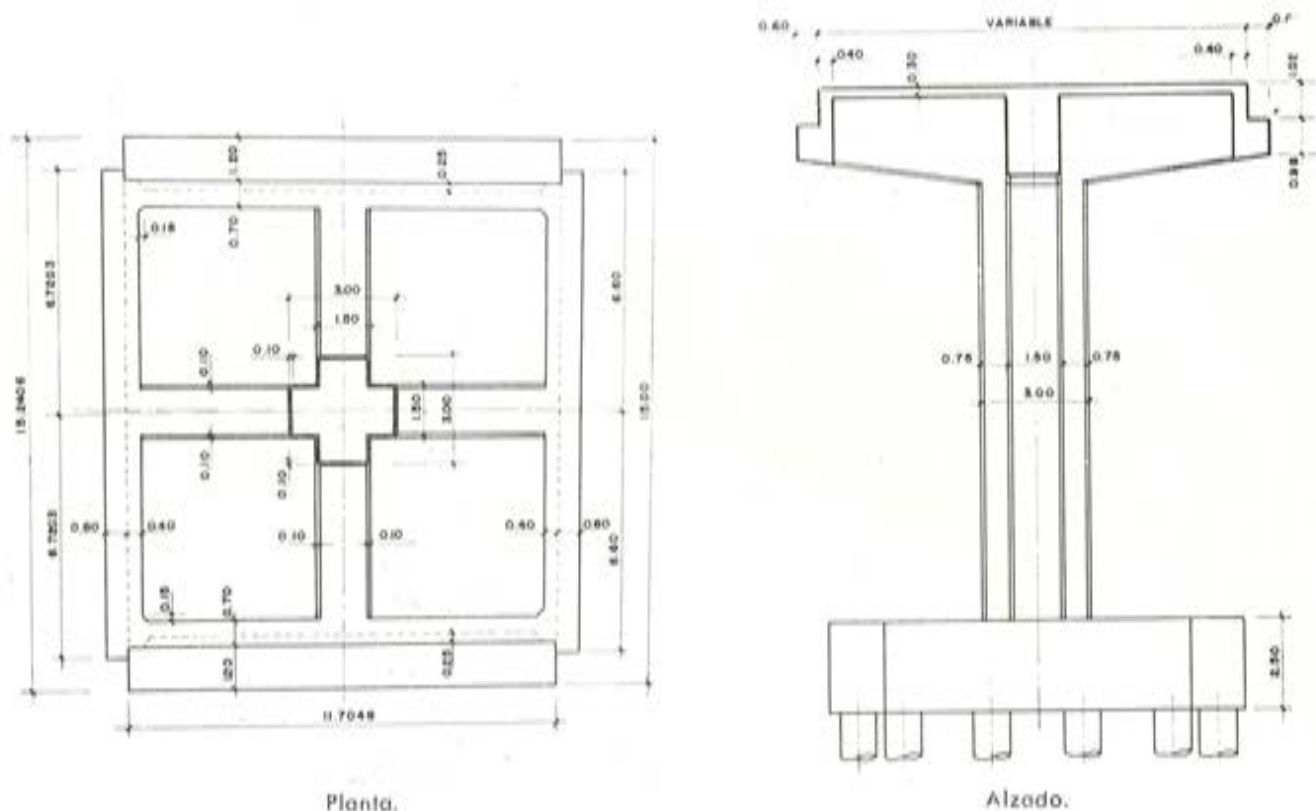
Viaducto de Torre Baró (Pila "Seta").
